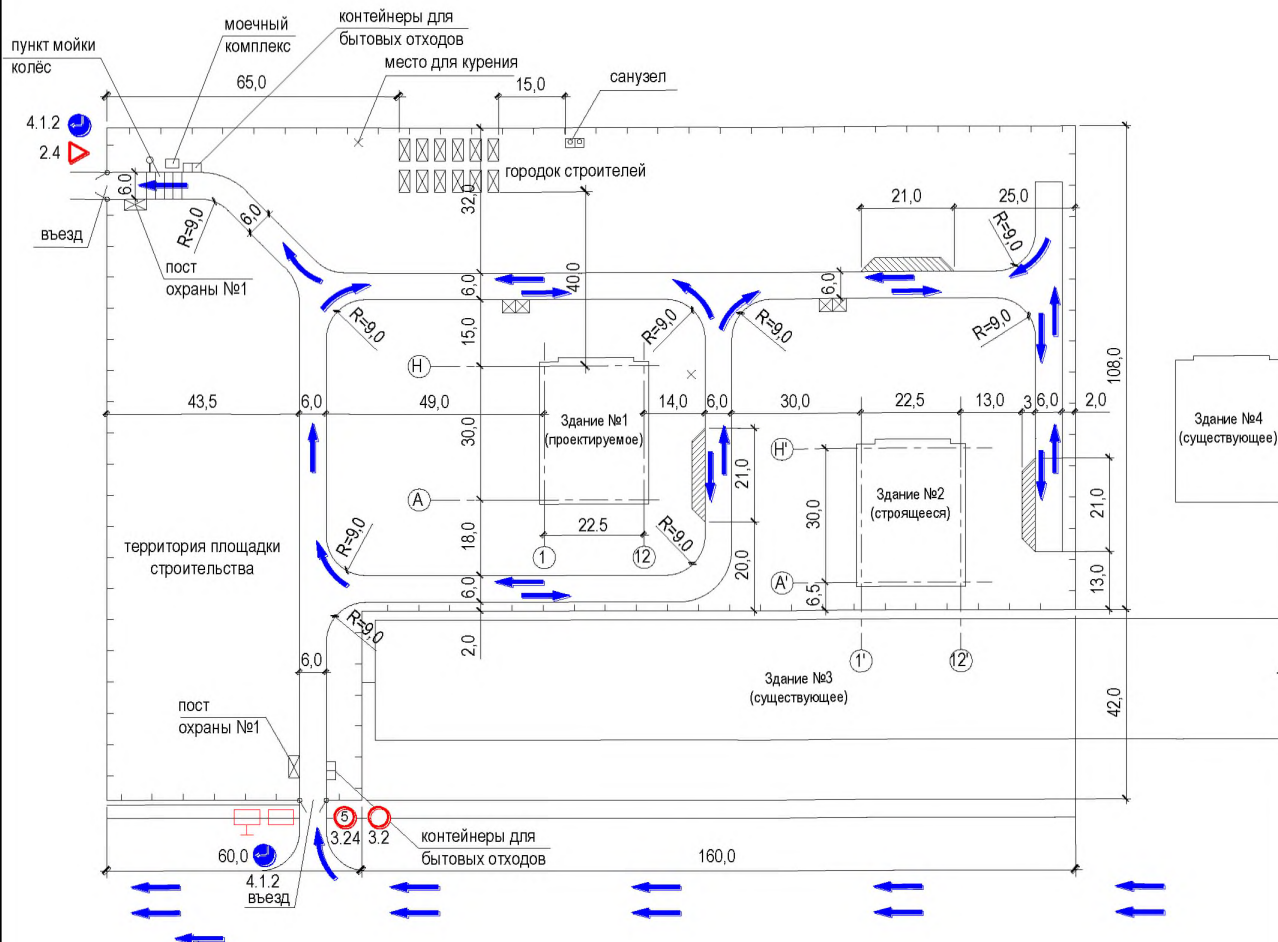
Схема размещения пункта мойки колёс на стройплощадке
